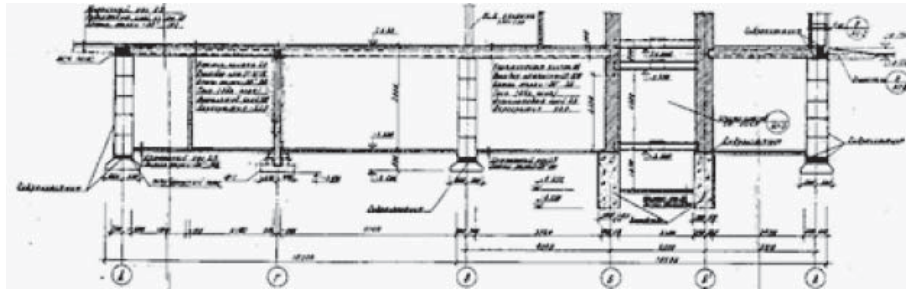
Діаметральний розріз будівлі (палі фундаментів умовно не показані)
